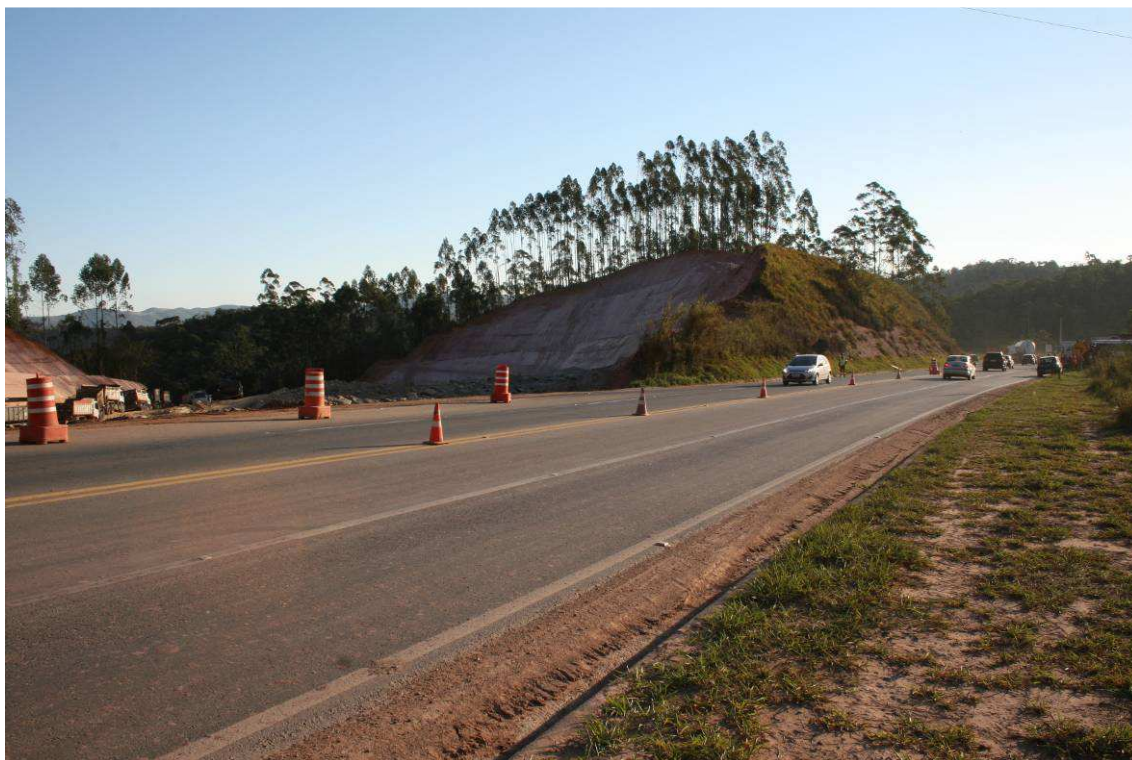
Obras de duplicação – novo traçado – km 26,6 a 27,3
